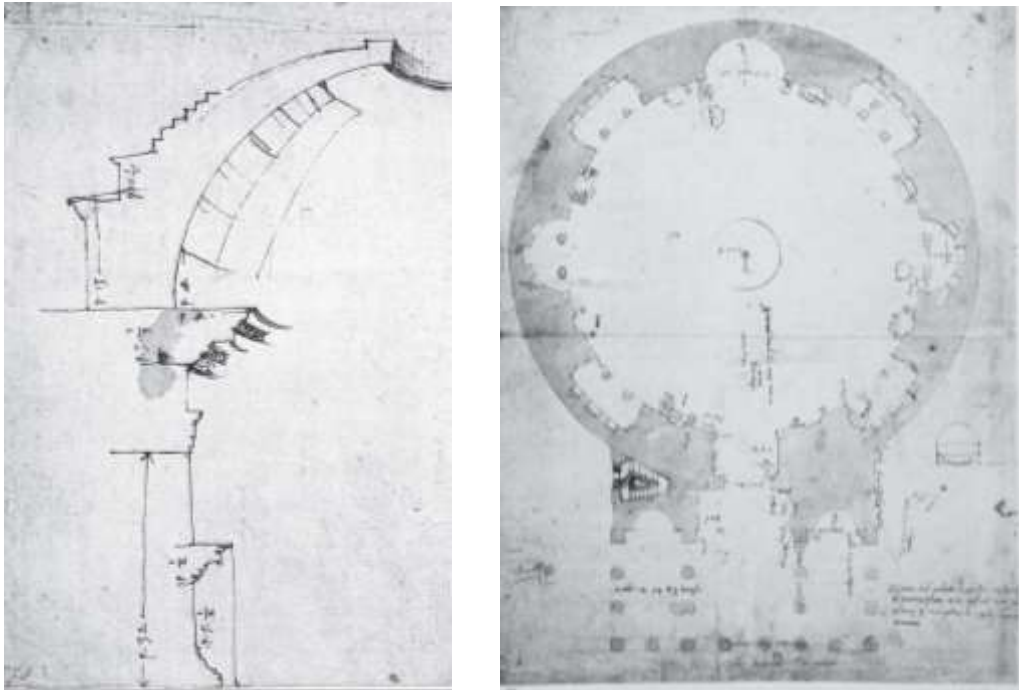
Sezione prospettica e pianta del Pantheon con le quote in palmi romani. - Baldassarre Peruzzi, 1511-13.
